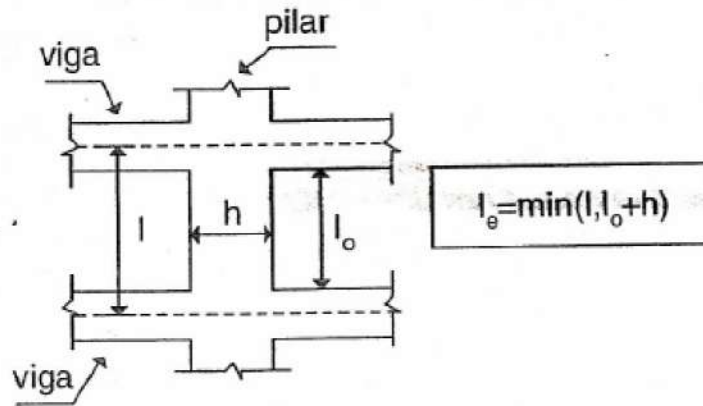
Determinação do comprimento de flambagem do pilar
